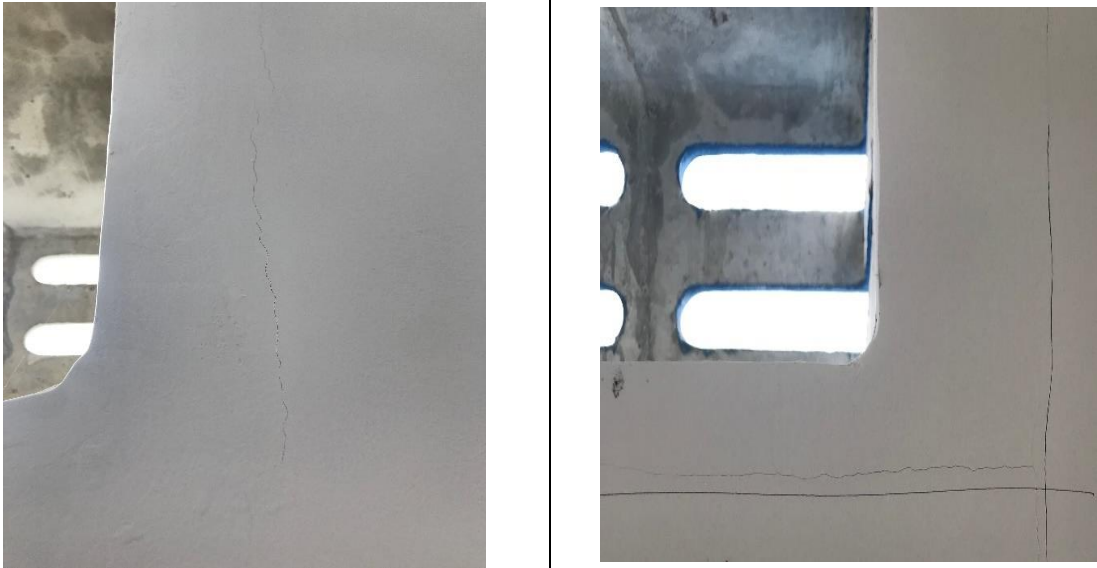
Ligação entre paredes de concreto e paredes de alvenaria
